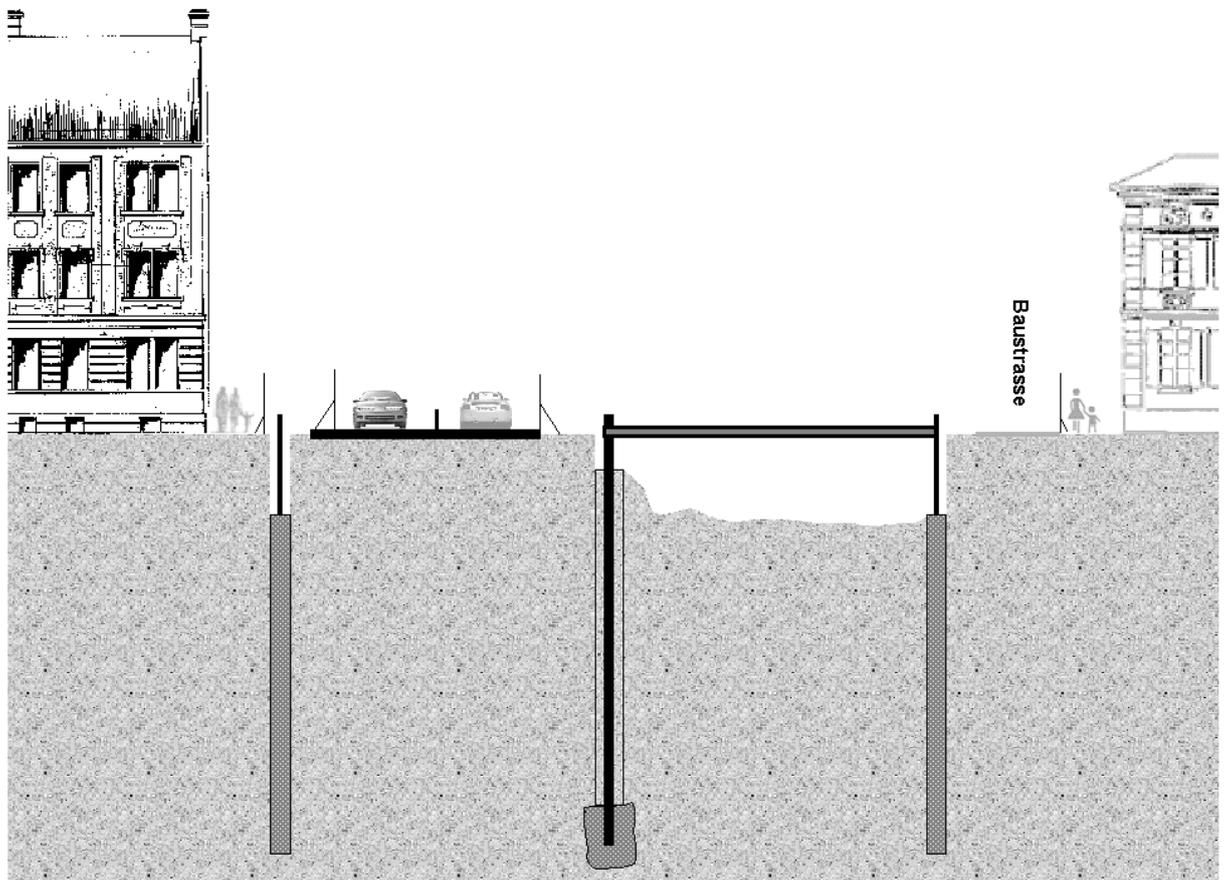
Voraushub unter der Hilfsbrücke und Installation der Hilfsbrücke mit einseitiger Verkehrsführung
